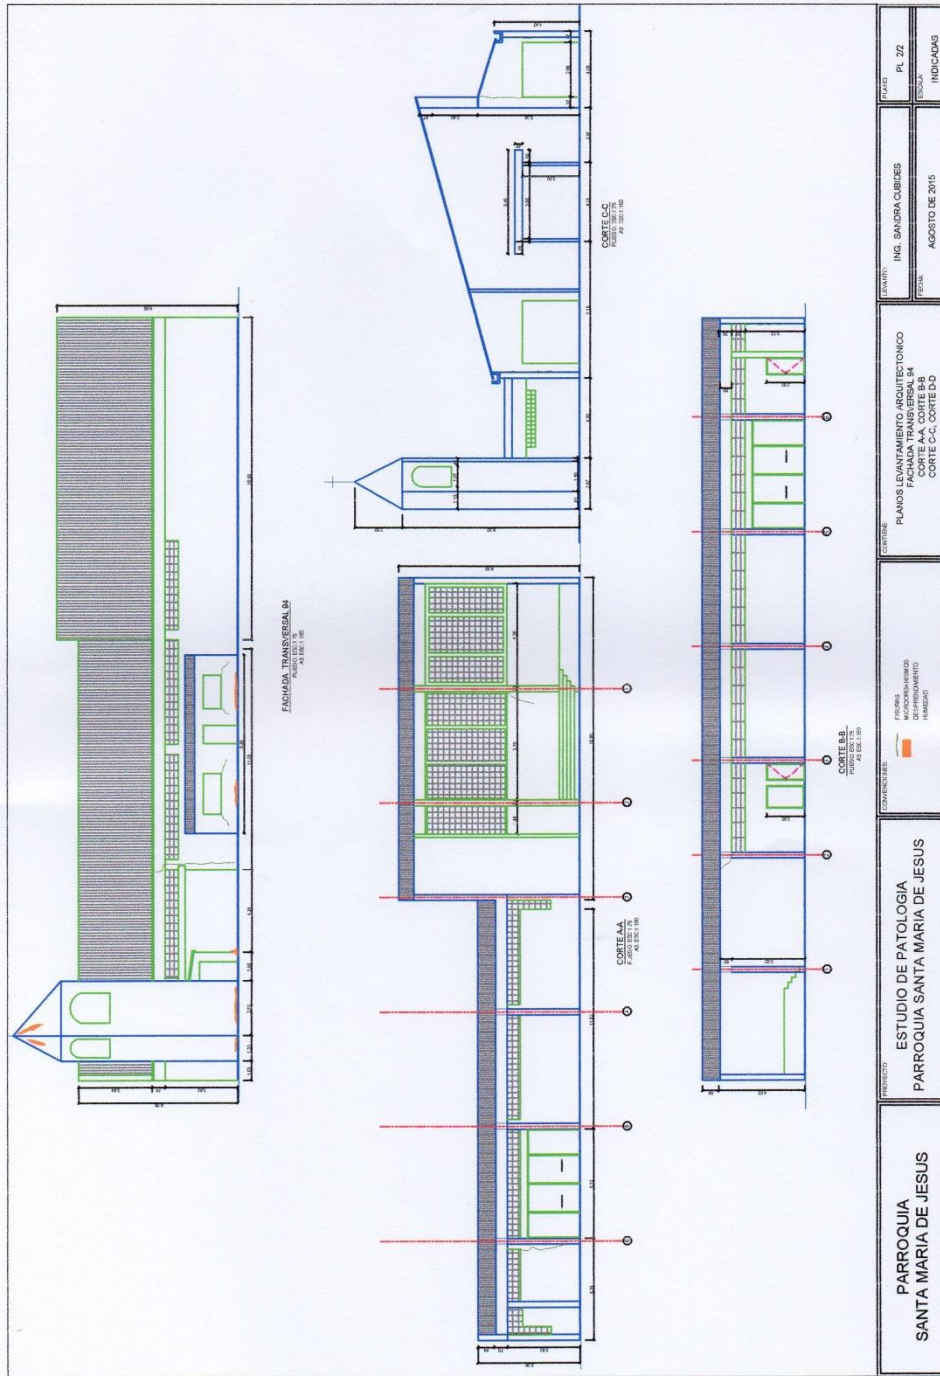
Plano de Levantamiento Arquitectónico (Fachadas y Cortes)
